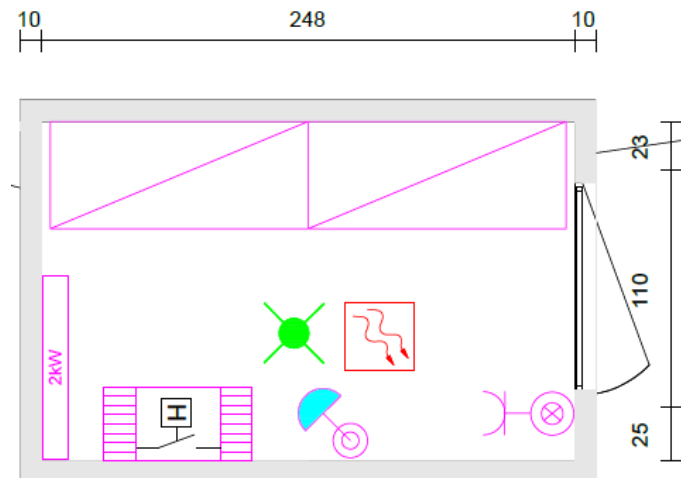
Grundriss des NSHV-Gebäudes, Quelle:[U18]
